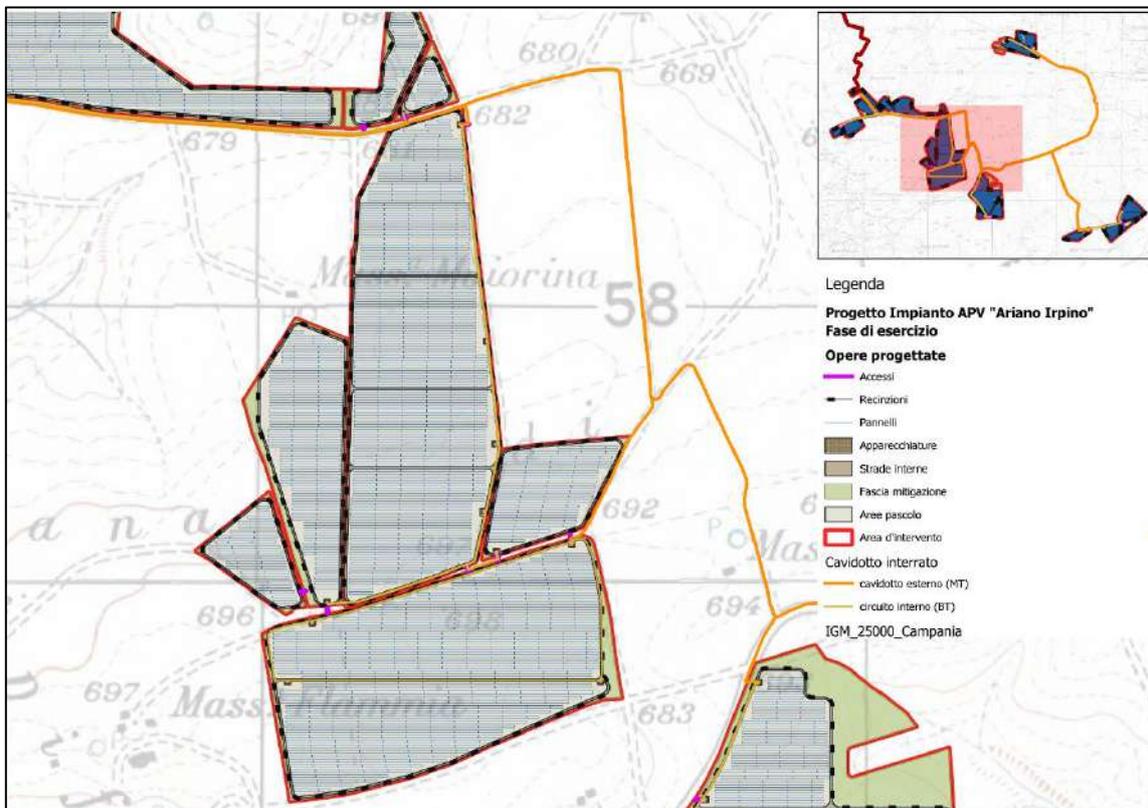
planimetria riportante i campi fotovoltaici in fase di esercizio
